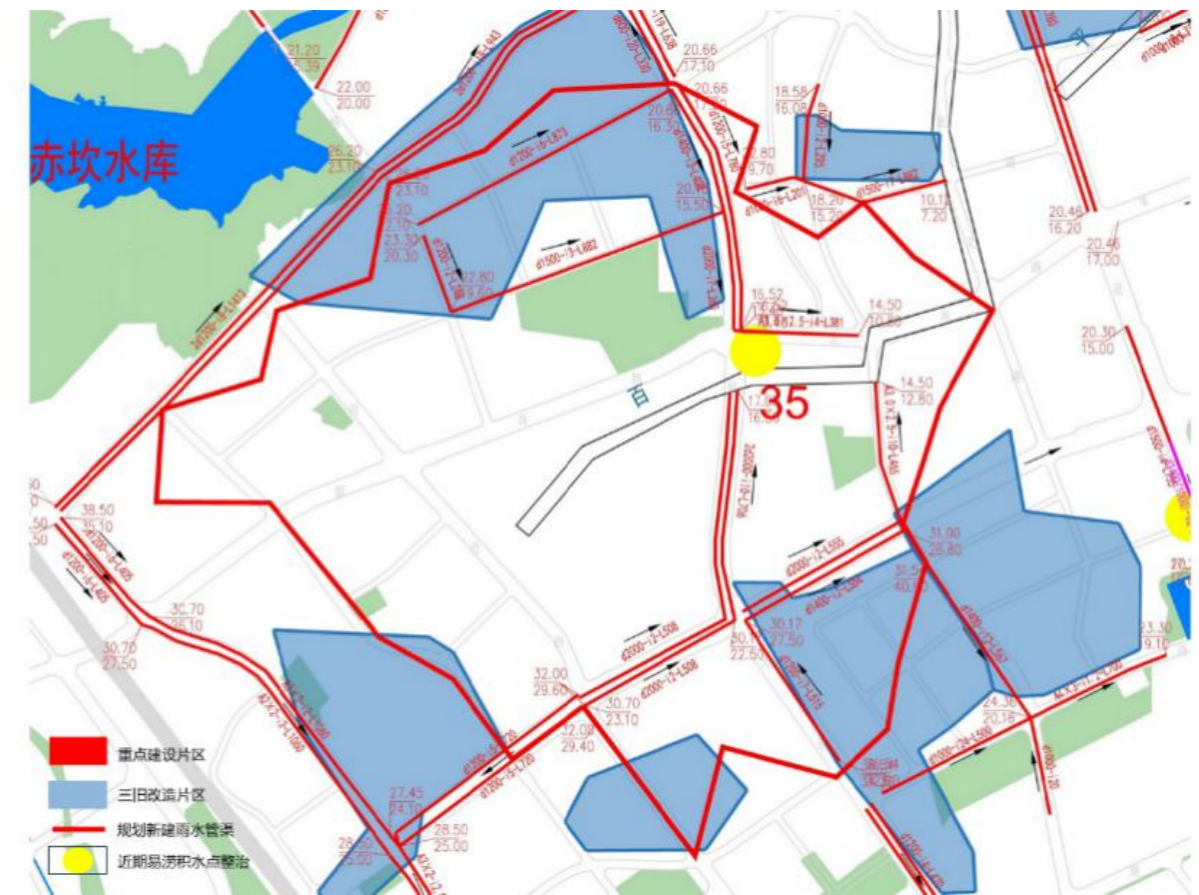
百姓渠上游分区近期新、改扩建雨水管渠平面图
